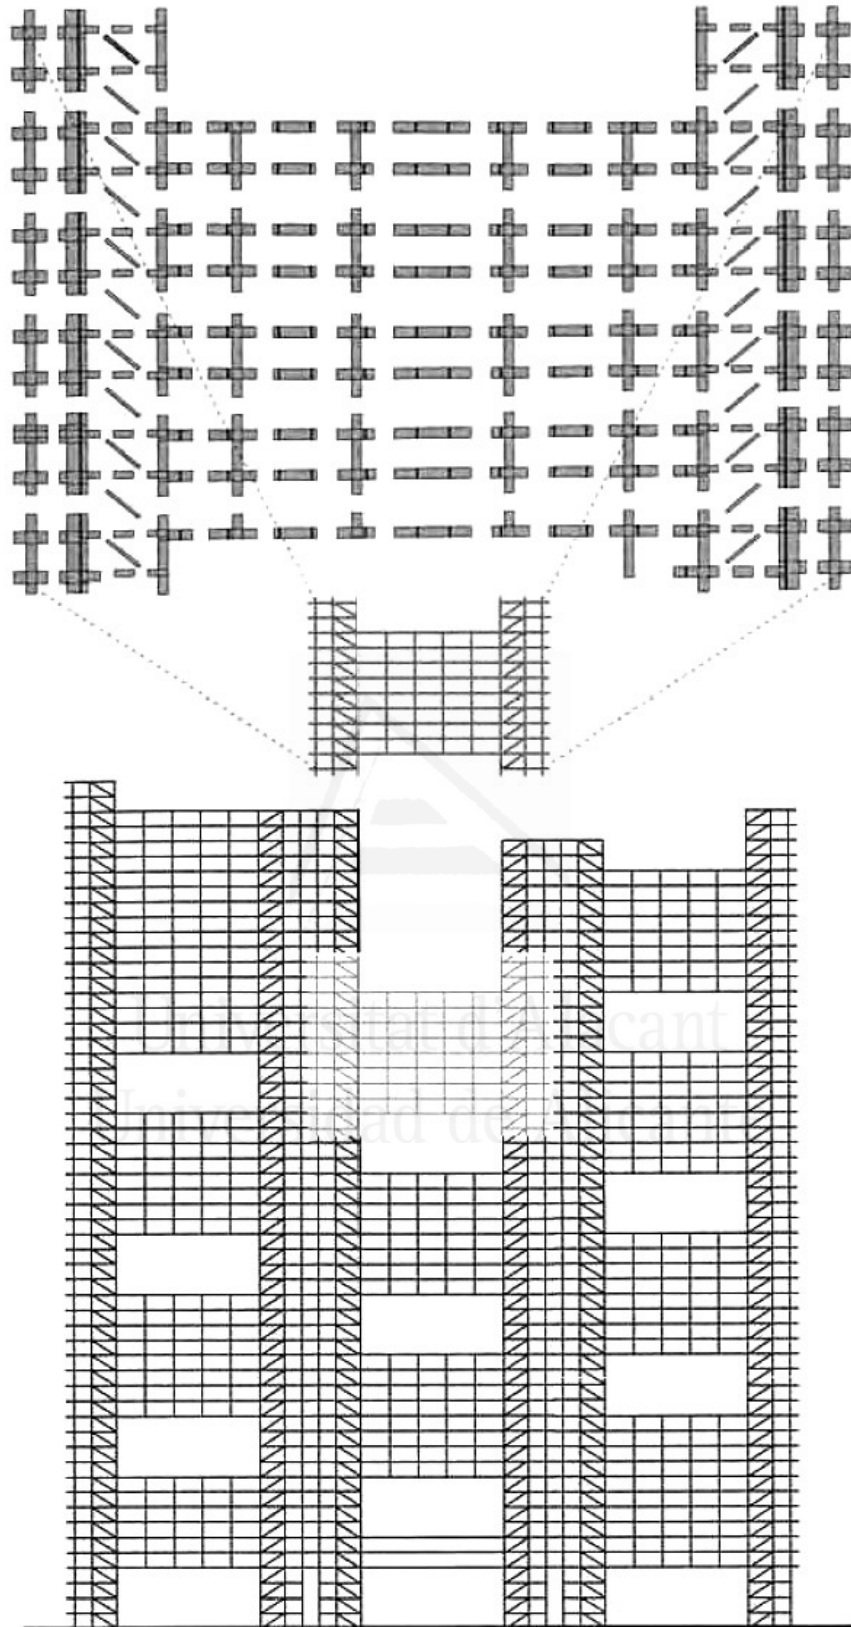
Modulación de la estructura prefabricada del tubo perimetral perforado. Ilustración extraída de "*Commerzbank, Frankfurt; Architects: Foster & Partners*" (Bailey et al., 1997, p.7).
